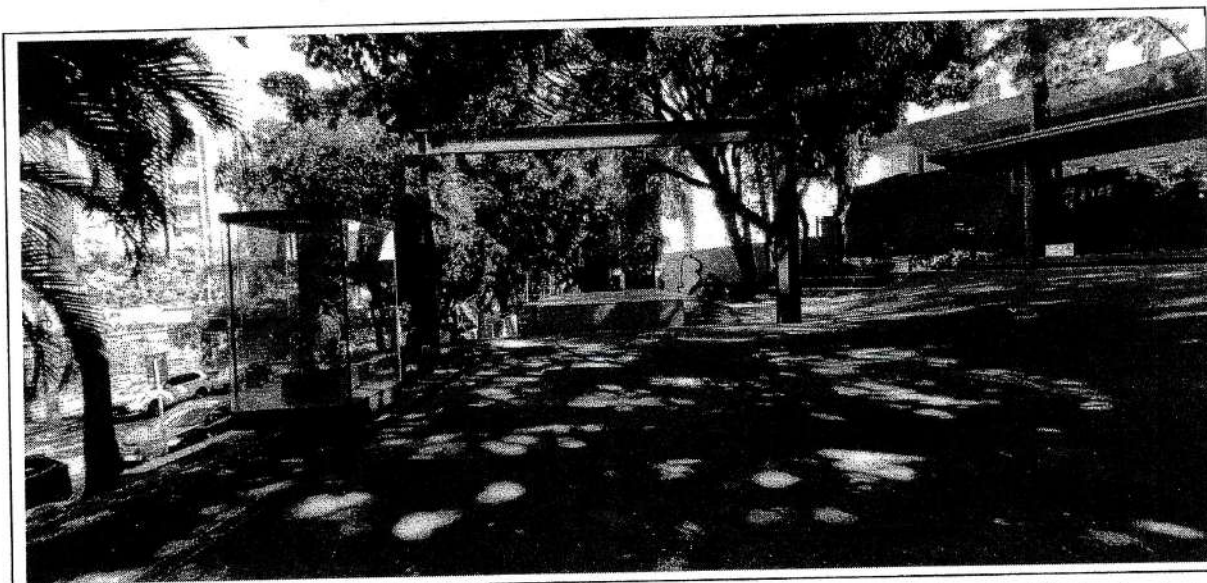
Circulação área externa – piso nivelado bem conservado. Não possui sinalização tátil. Ao fundo à esquerda, palco com acesso exclusivo por meio de escadas
